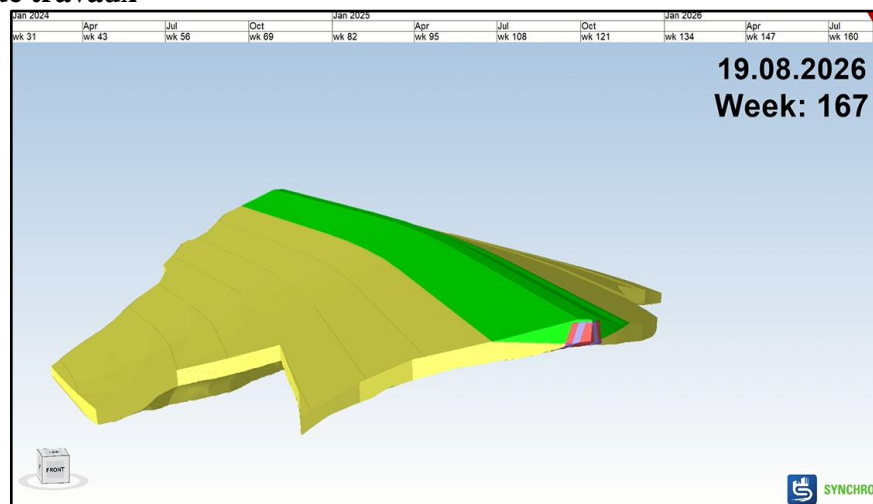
Fin de travaux de remblayage du barrage au 19/08/2026.
